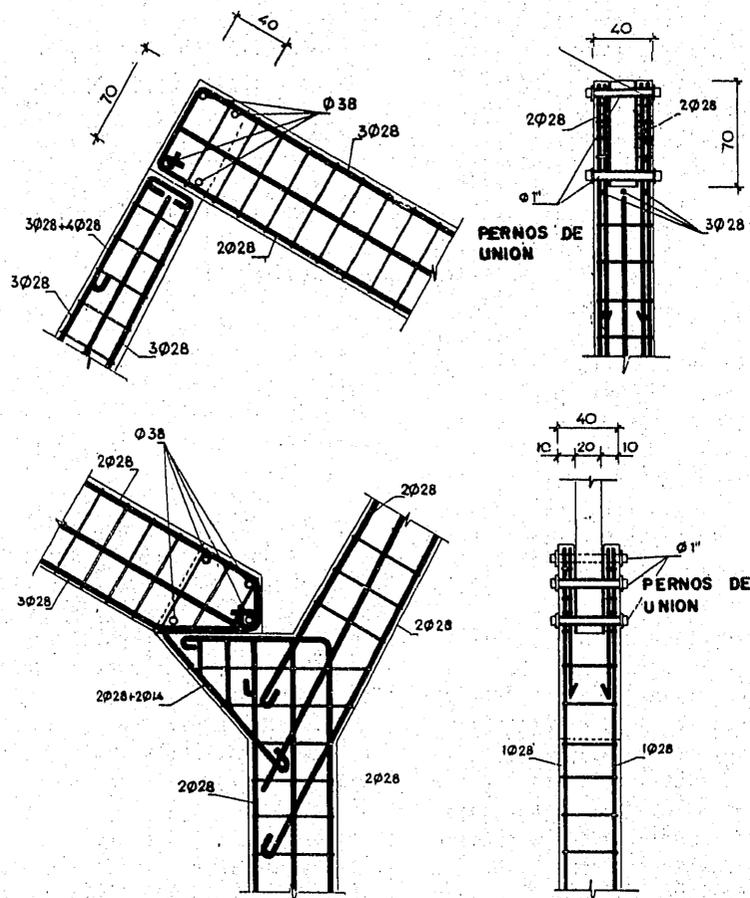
^a — Detalle de las armaduras de ambos elementos.
